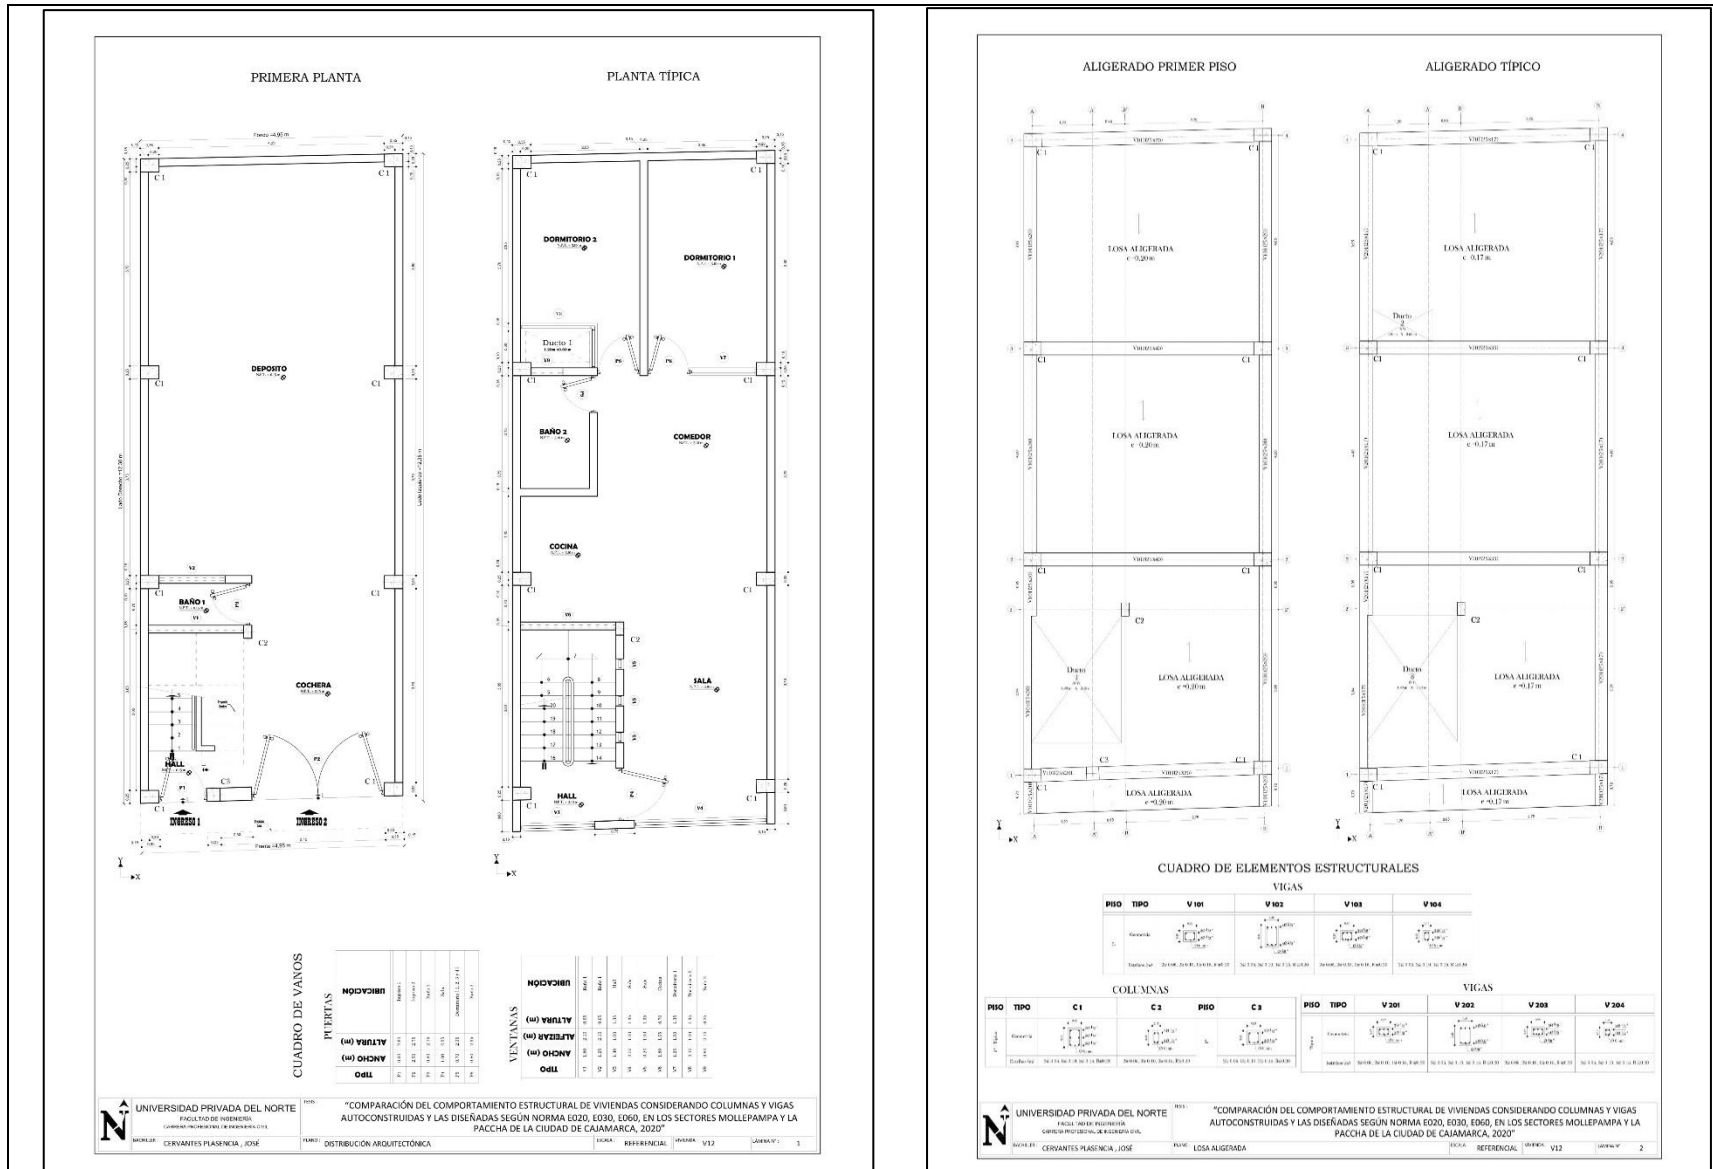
Planos de arquitectura y losa aligerada vivienda 12
